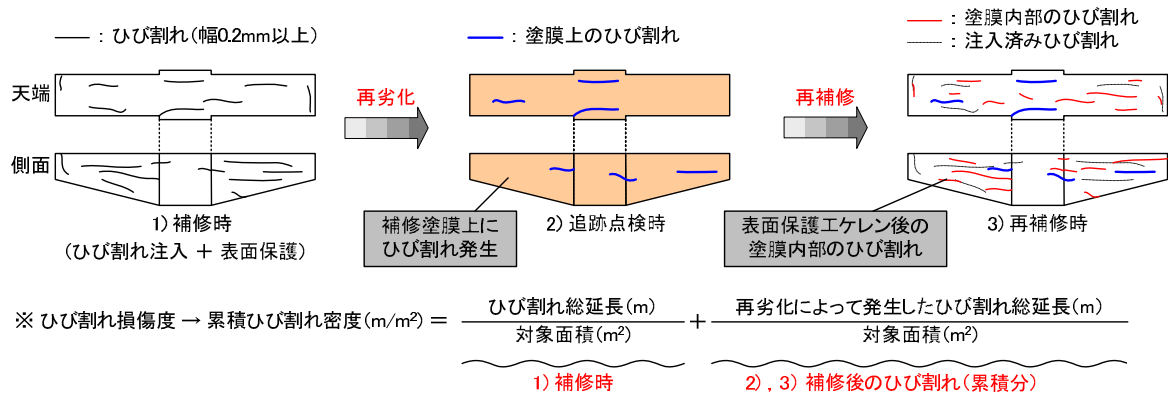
外観ひび割れからの累積ひび割れ密度 算出方法
